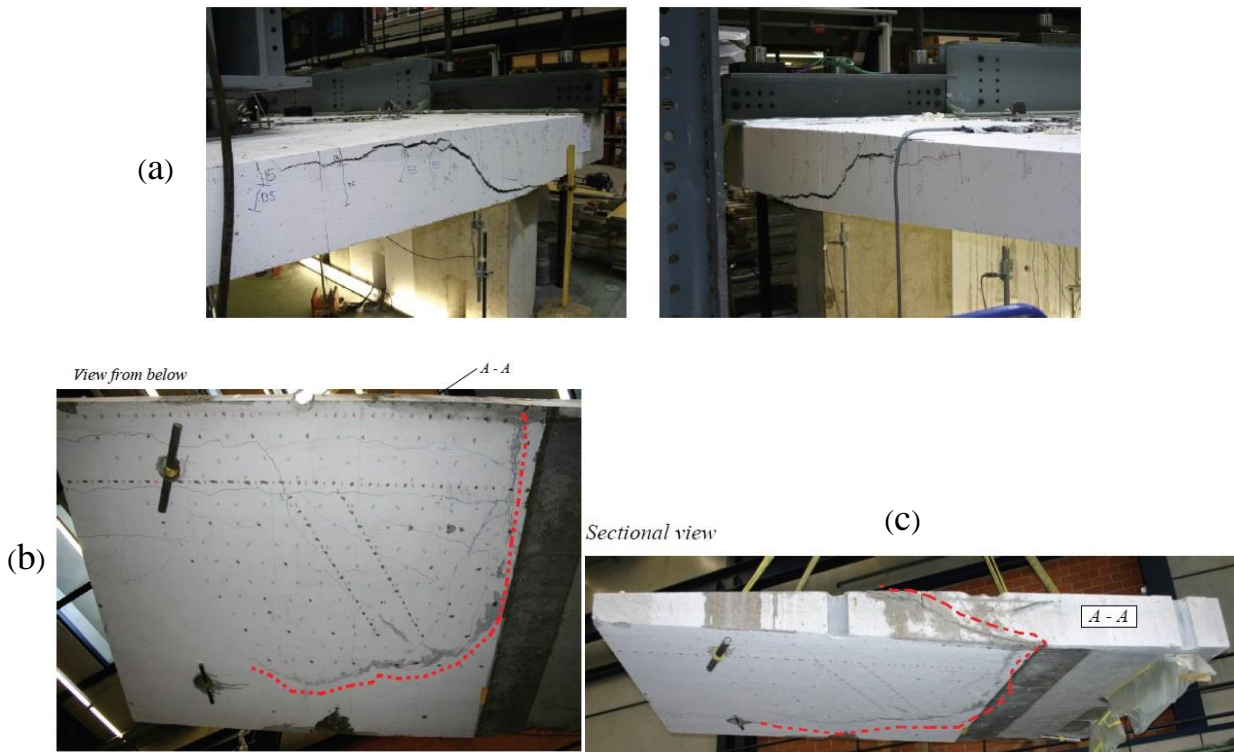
Exemple de rupture par cisaillement de dalle en béton armé : (a) faces latérale ; (b) face inférieure ; (c) coupe transversale Rodrigues, 2007 [20]
